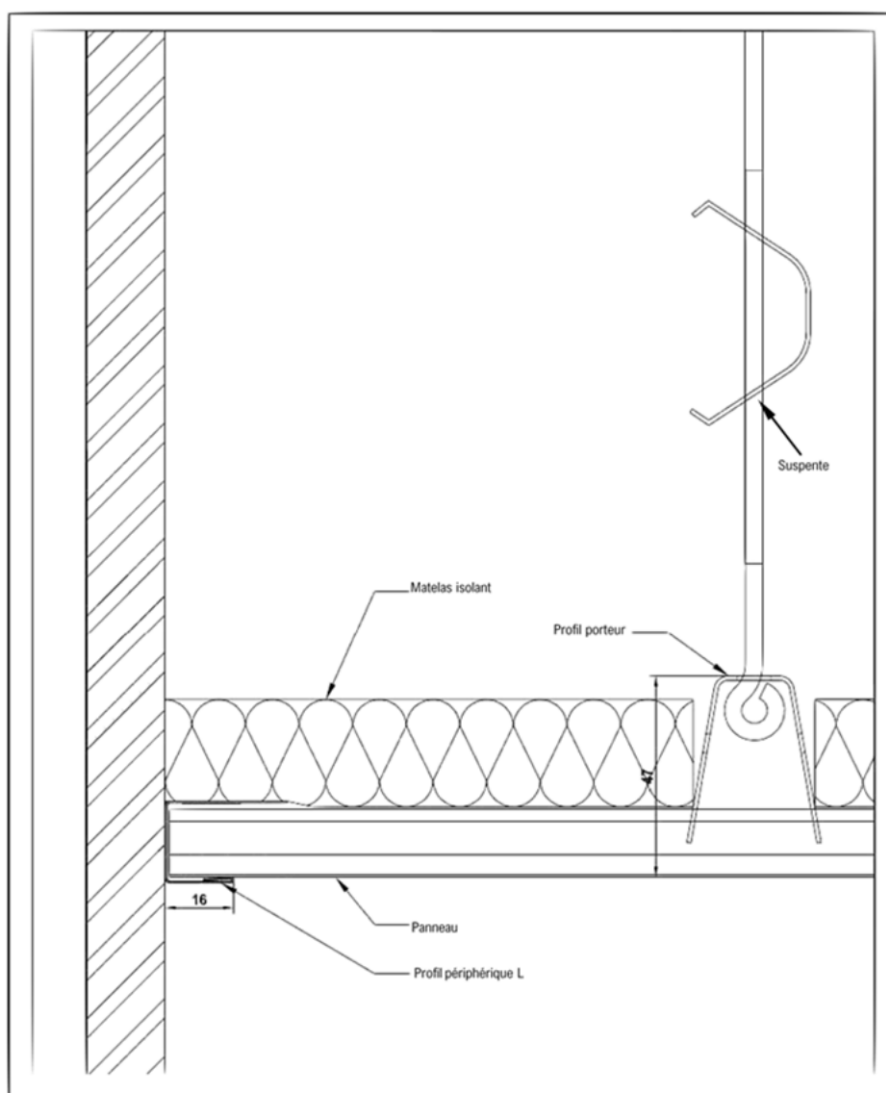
coupe longitudinale du plafond Easy-Klima Plus®
